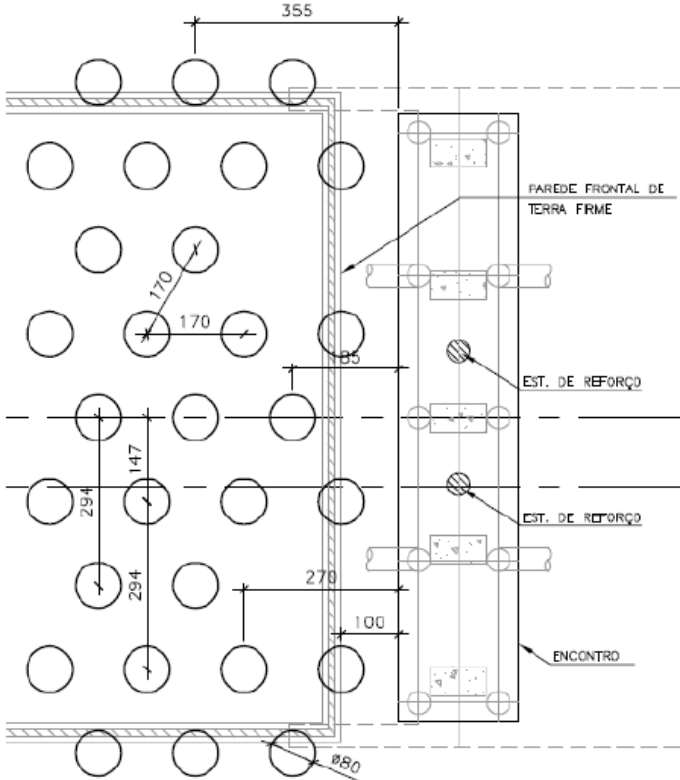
Detalhe da distribuição da malha das colunas de brita (Projeto)
